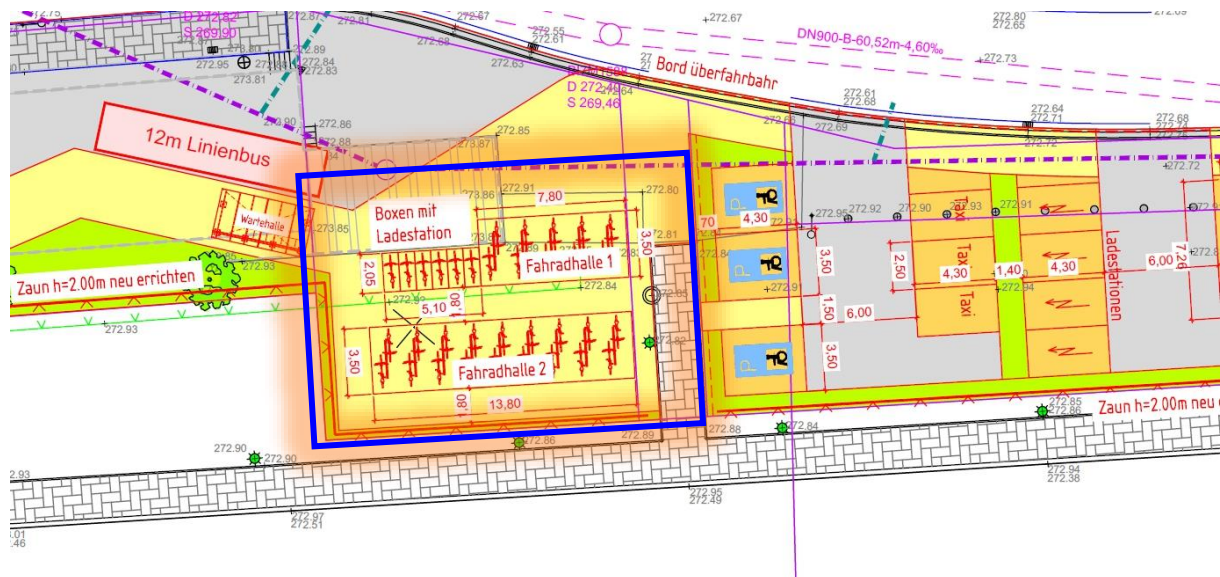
Geplante B+R-Anlagen am Bahnhof Biedenkopf (vgl. Stadt Biedenkopf, 2019)
